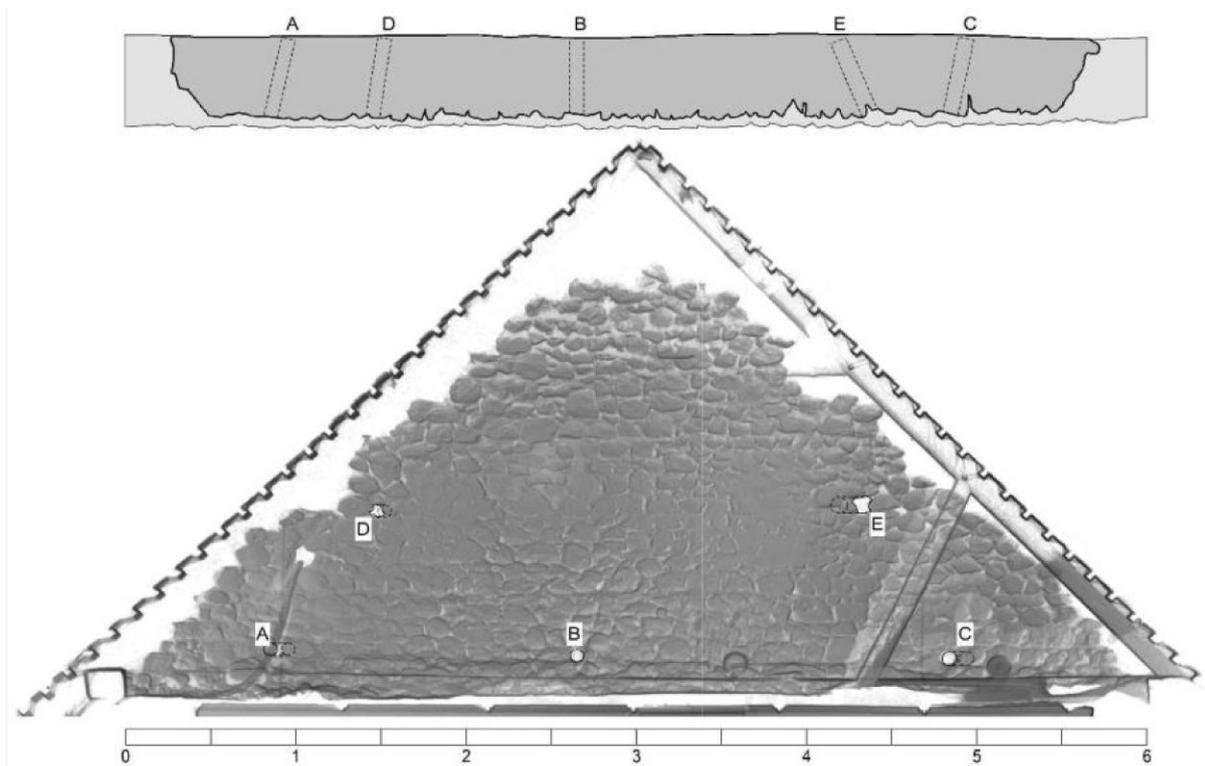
, Westliche Giebelwand, Grundriss und Innenansicht
